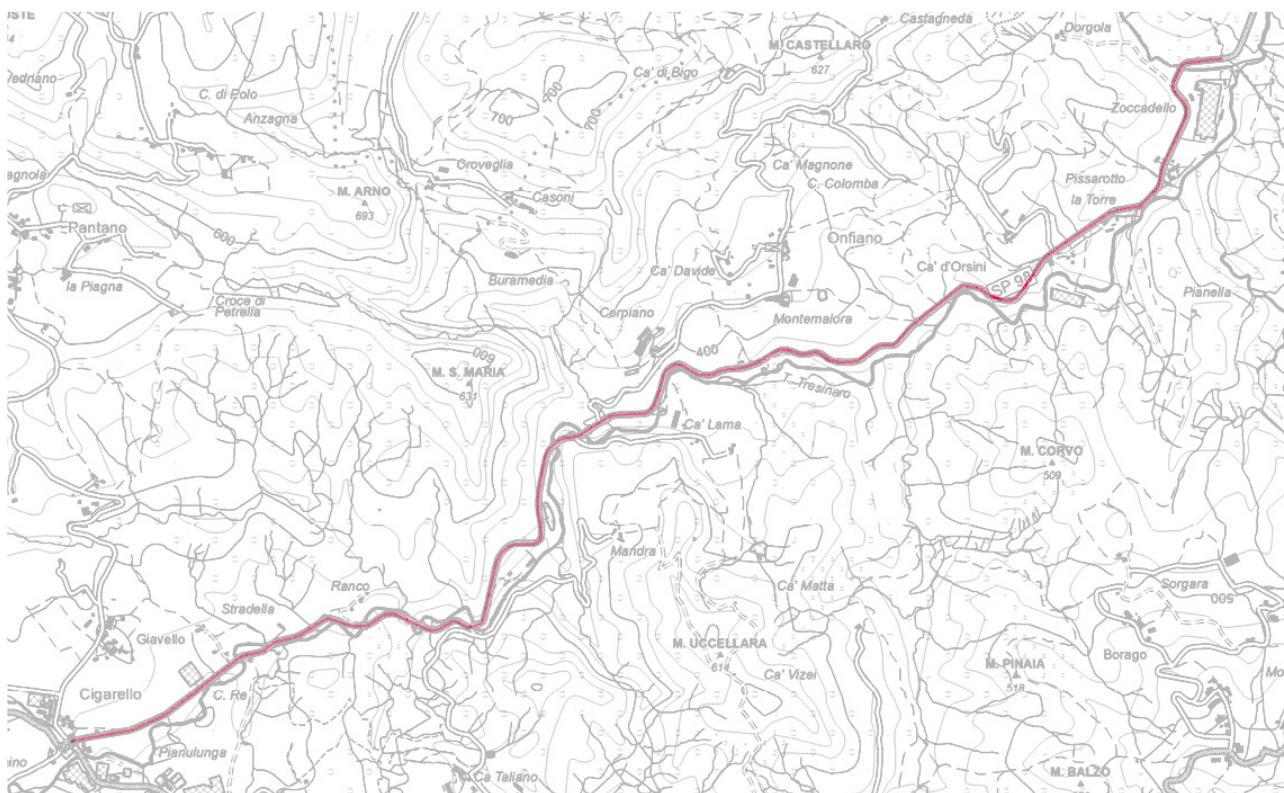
Planimetria strada SP 98 compresa tra le chilometriche di intervento
